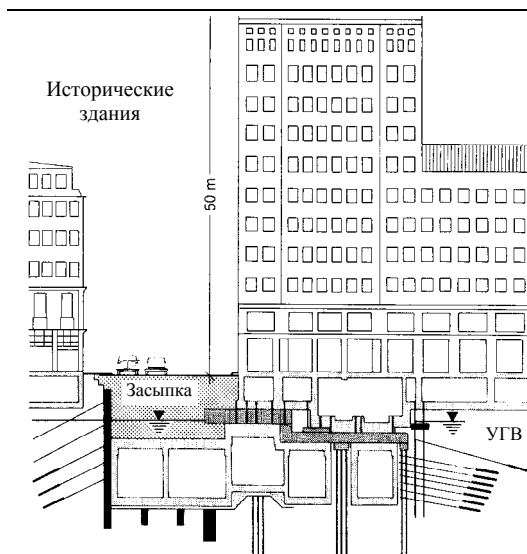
Перманентное усиление фундамента обыкновенными корневидными сваями и связанной стержневой стеновой конструкцией
